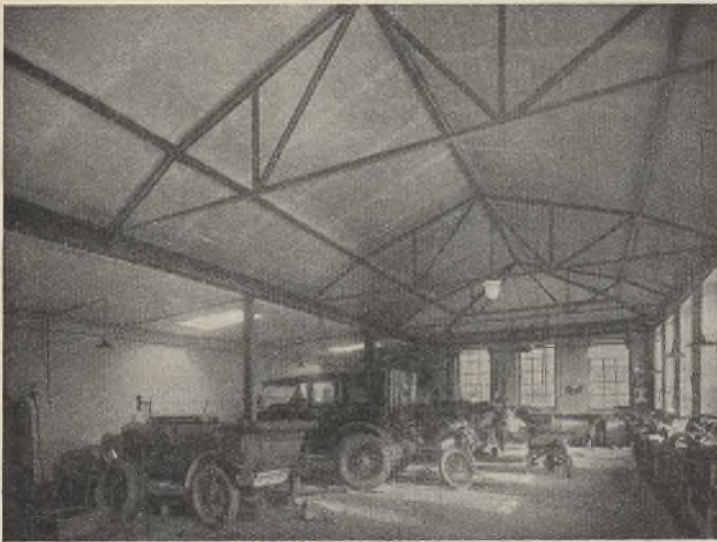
Automobilhalle mit geschweißter Stahlkonstruktion.
